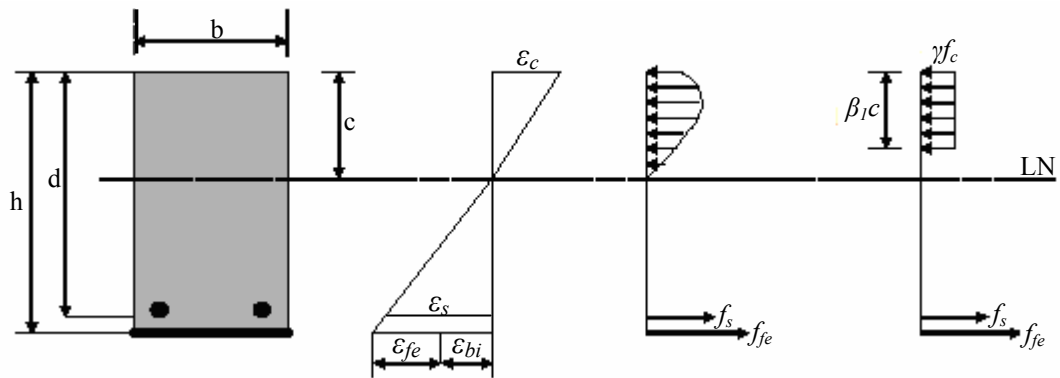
Seção de Concreto Reforçada com FRP no Estado Limite Último
